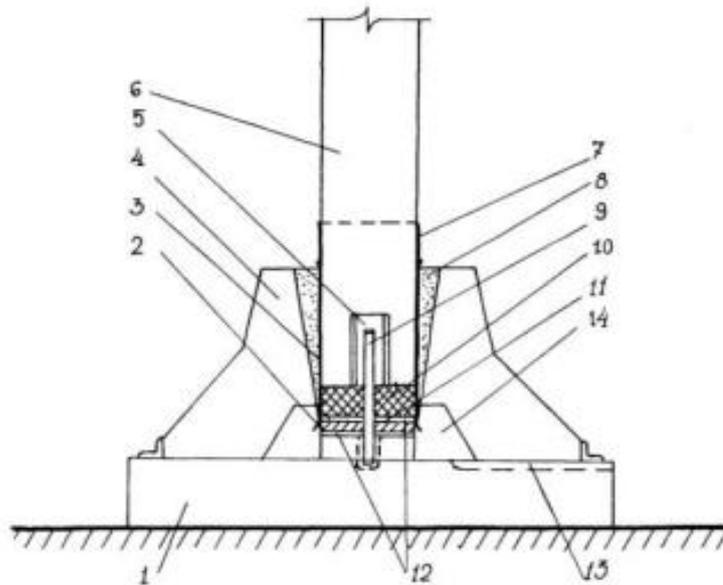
Фундамент із термопластичним елементом: 1-фундаментна плита;
